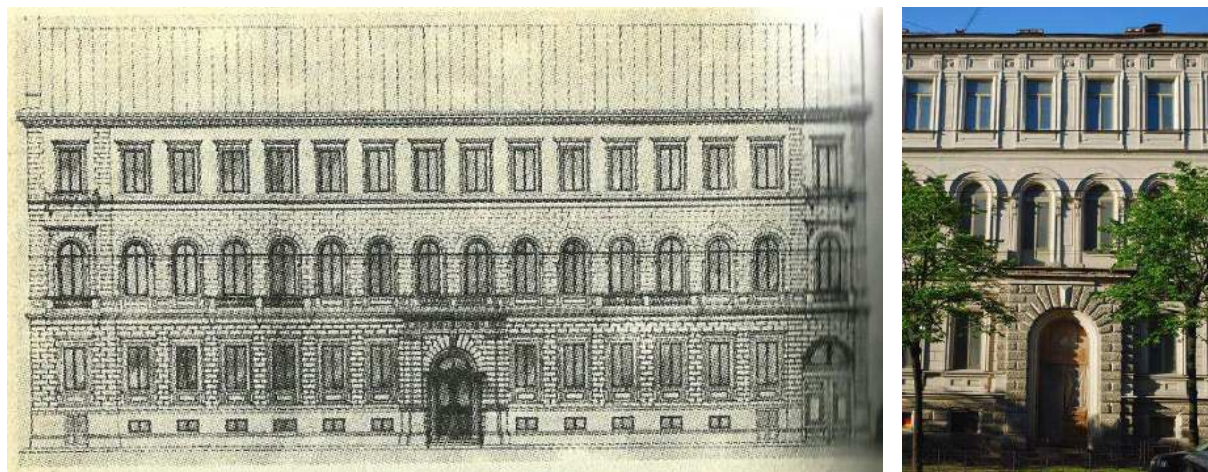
Доходный дом академика архитектуры А.К. Кольмана, 1859 – 1860 гг., арх. Е.И. Ферри-де-Пиньи (слева – проект фасада, справа – фрагмент уличного фасада)
